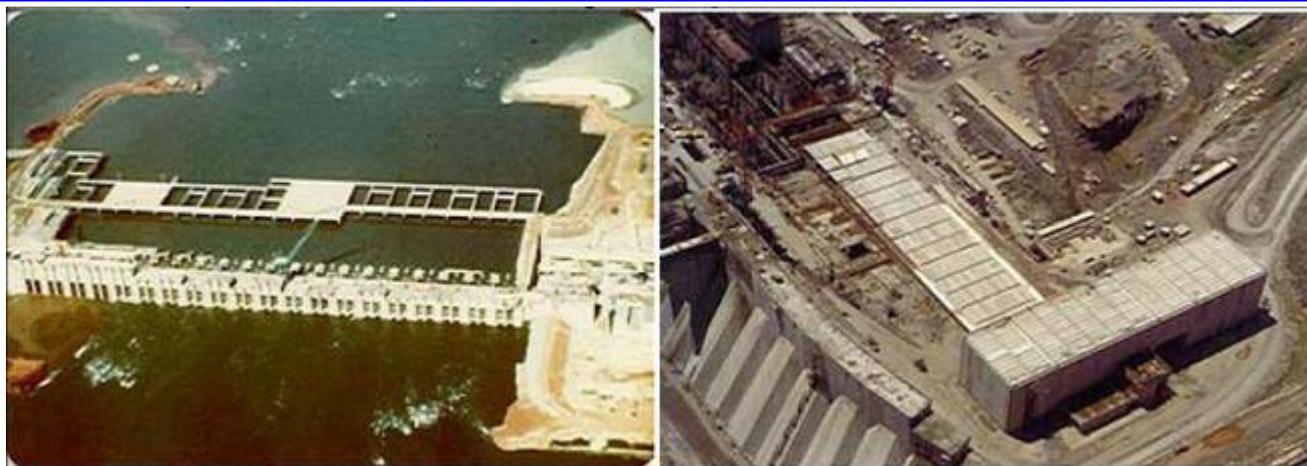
Uso de Pré-moldados de concreto em estruturas de Barragens (meados de 1960)
